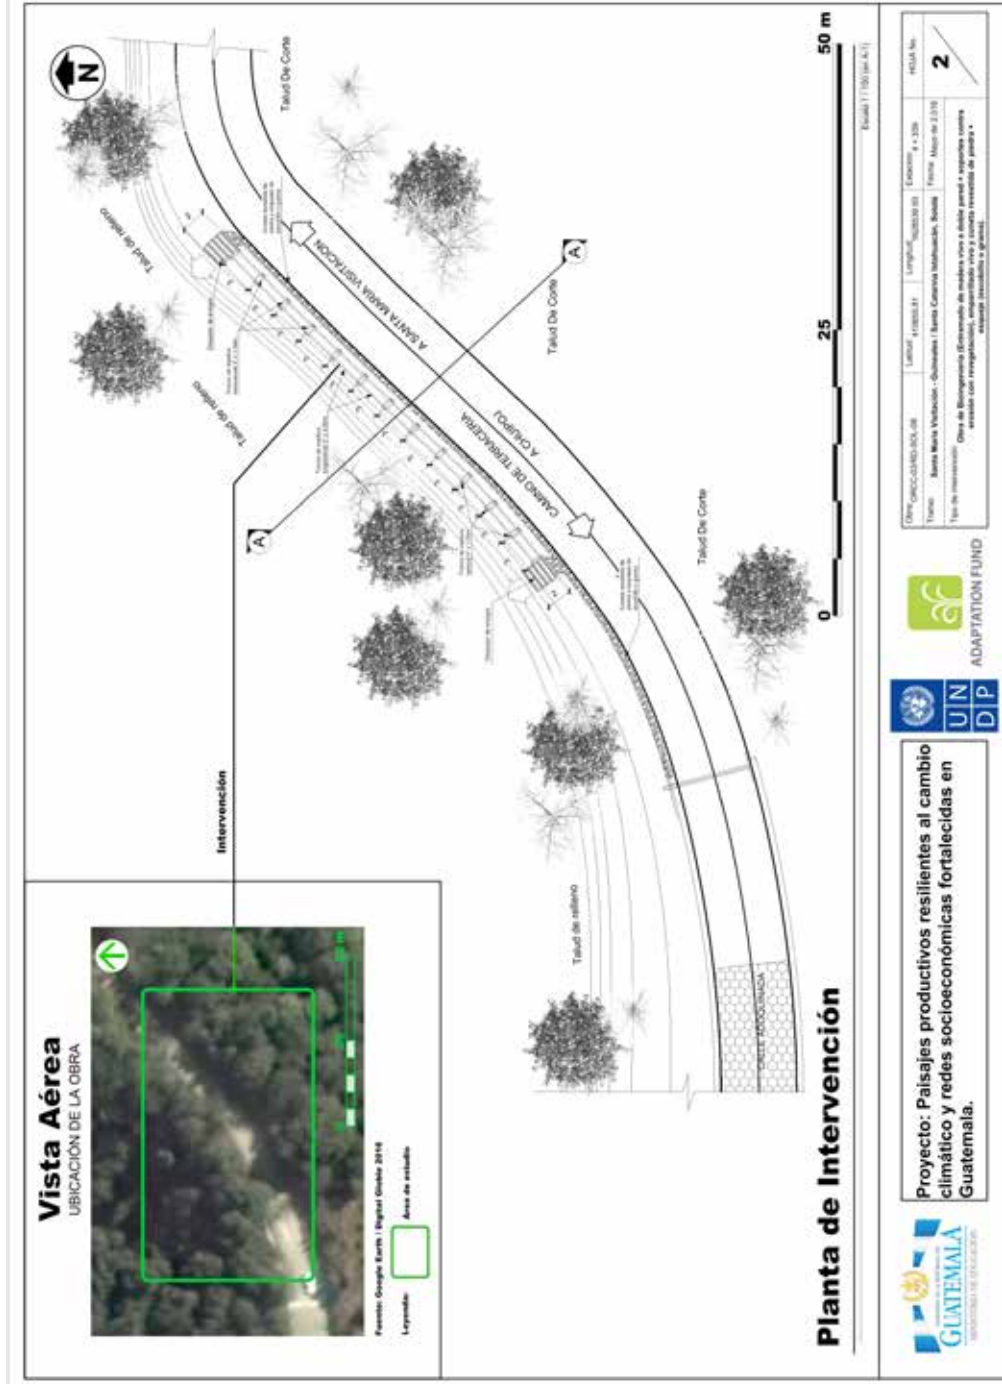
A. PLANTA DE INTERVENCIÓN. Planificación Obra ORCC-01/RD-SOL-08. Tramo: Santa María Visitación-Guineales, Sta. Catarina Ixtahuacán).
